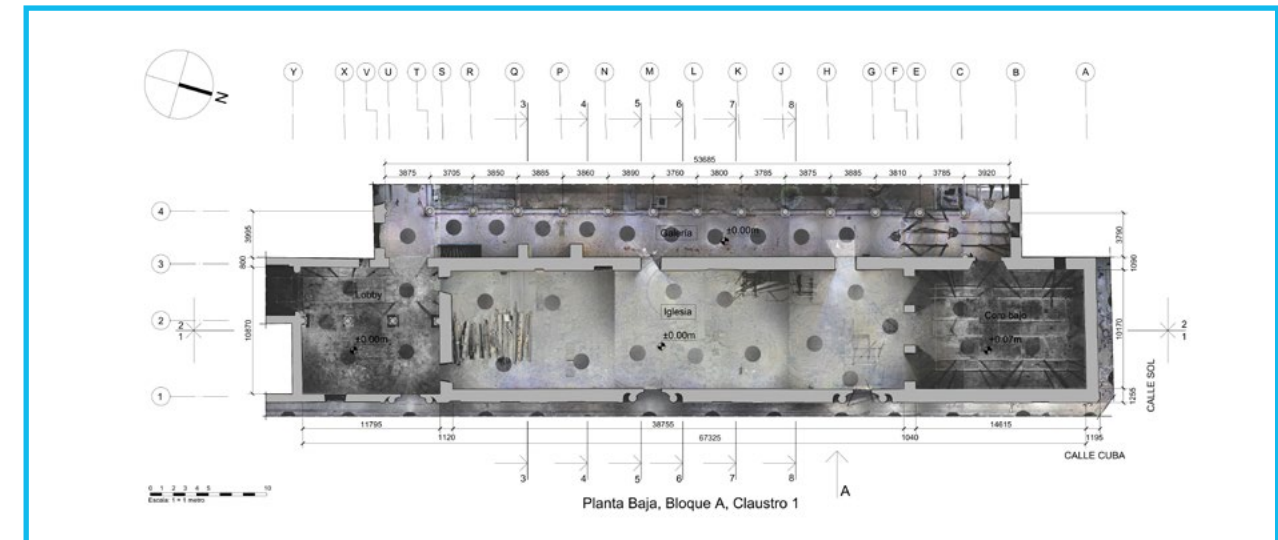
Ortoimagen obtenida de la planta baja, bloque A, primer claustro
